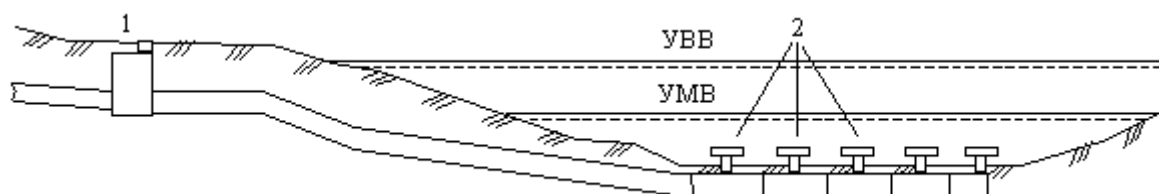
Схема оголовка рассеивающего выпуска: 1 – береговой колоде; 2 – оголовки с насадками
